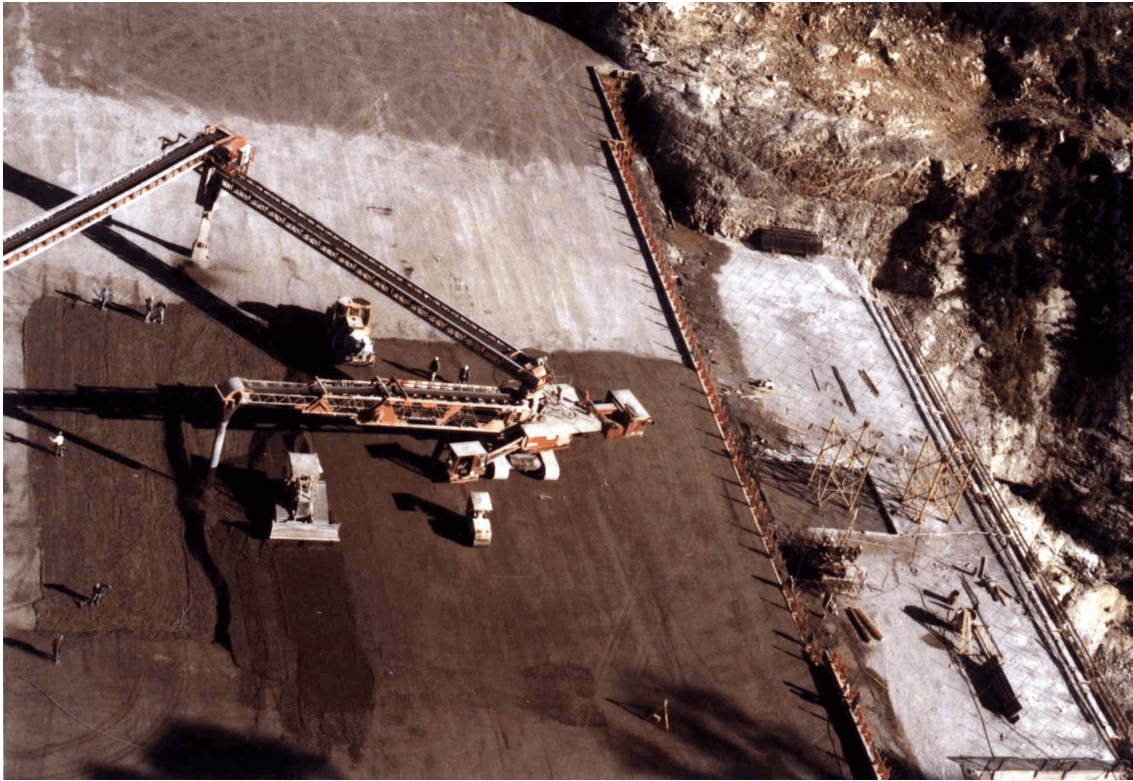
Máquina Crawler Placer operando en la construcción de la presa Pangué, Fuente: Adolfo Ochoa
